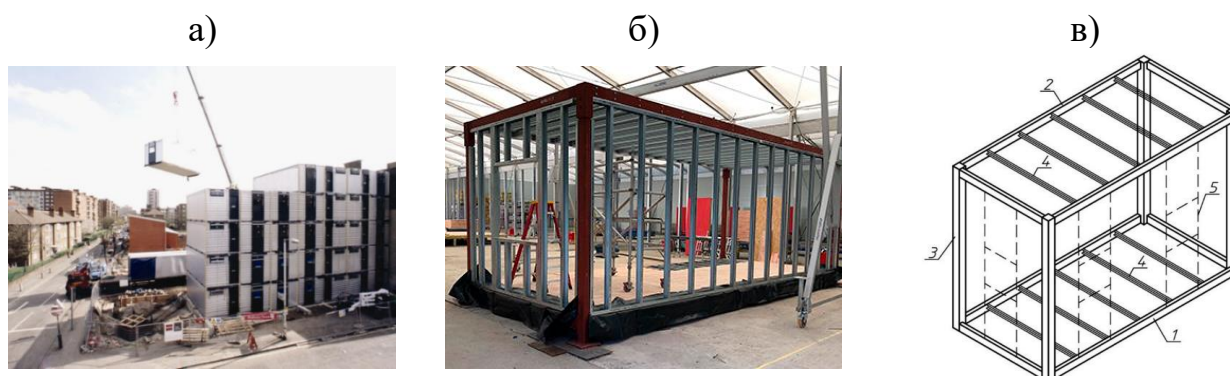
Конструкция модульного здания: а) модульное здание; б) каркас модуля с опорными колоннами; в) схема каркаса модуля. 1 – нижняя горизонтальная рама; 2 – верхняя горизонтальная рама; 3 – колонна; 4- балки настила; 5 – стеновое ограждение (при необходимости)
